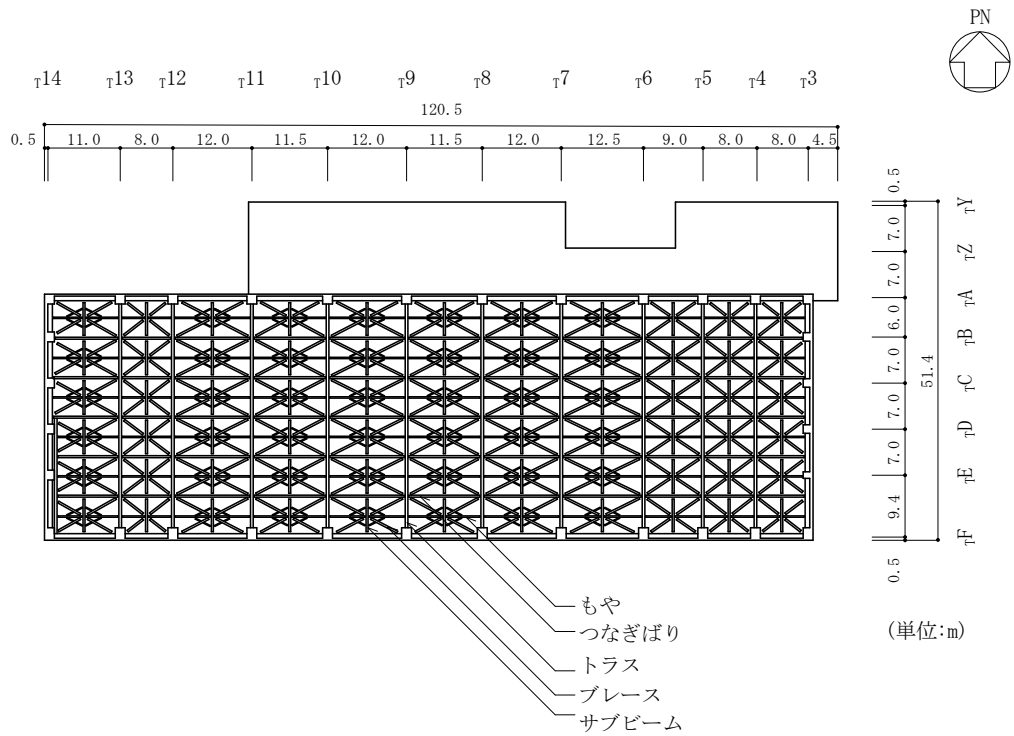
(6) タービン建物の概略平面図 (EL 41.6m)
